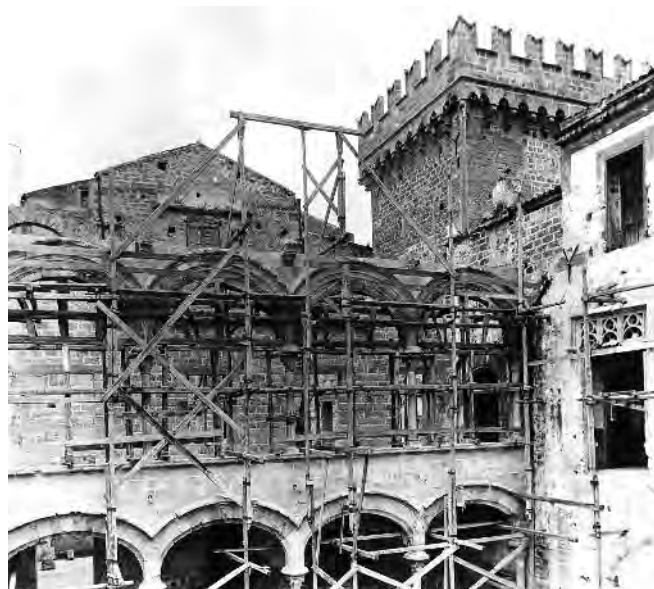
Palermo. Palazzo Abatellis, il cantiere di rimontaggio e ricostruzione del loggiato, in questa fase l'intervento sulla torre è stato già completato (MBACT, ICCD - Archivio MPI, fondo P).
